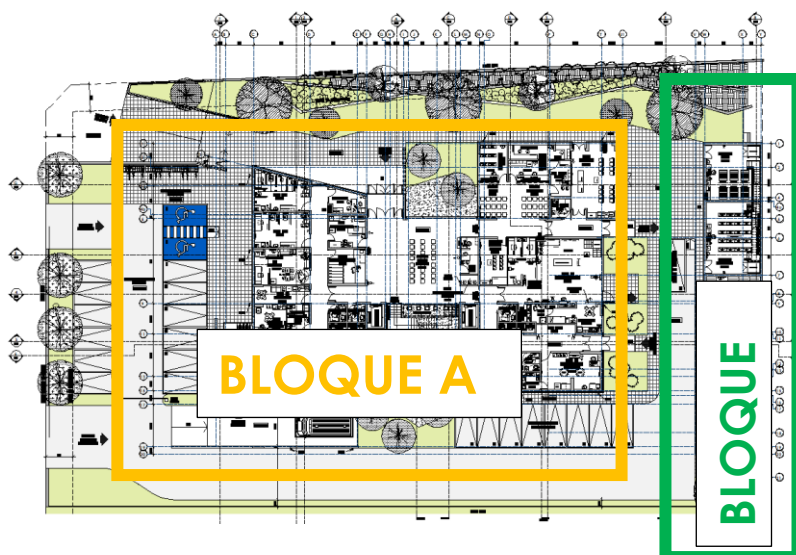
Planta de arquitectura 1er piso Bloque A y Bloque B.
